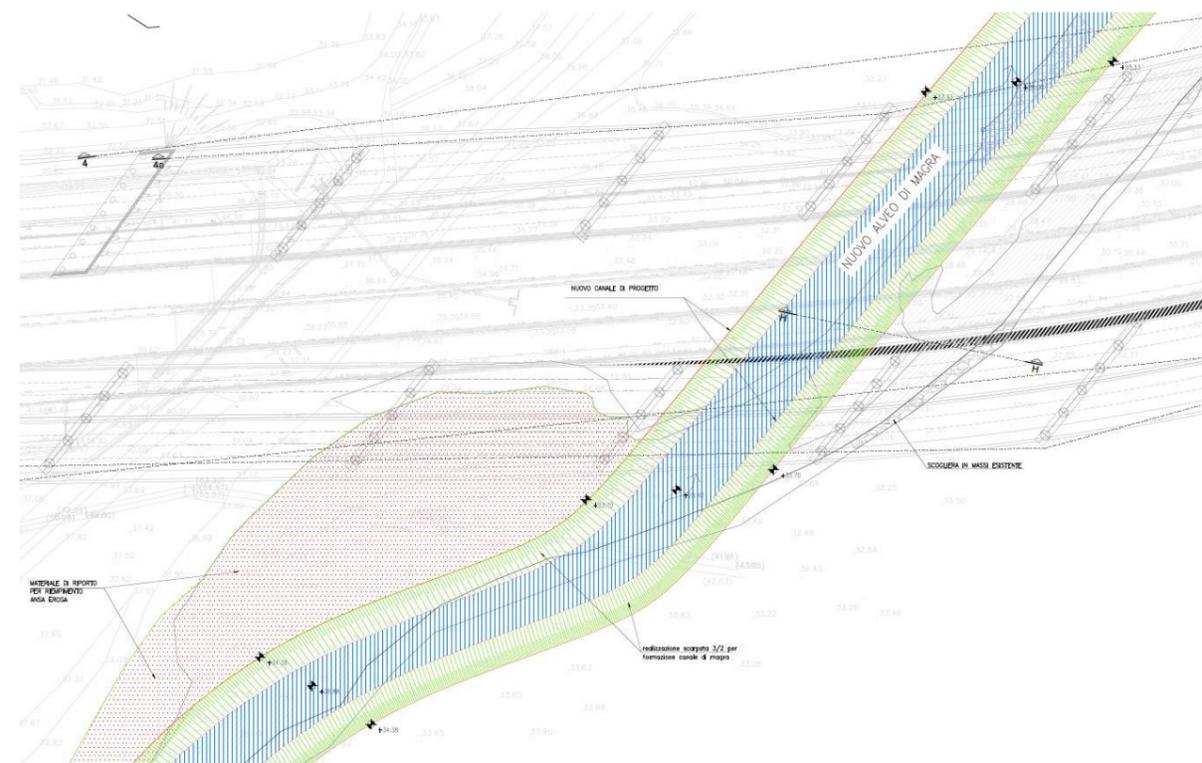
estratto da Planimetria delle sistemazioni idrauliche²⁰
